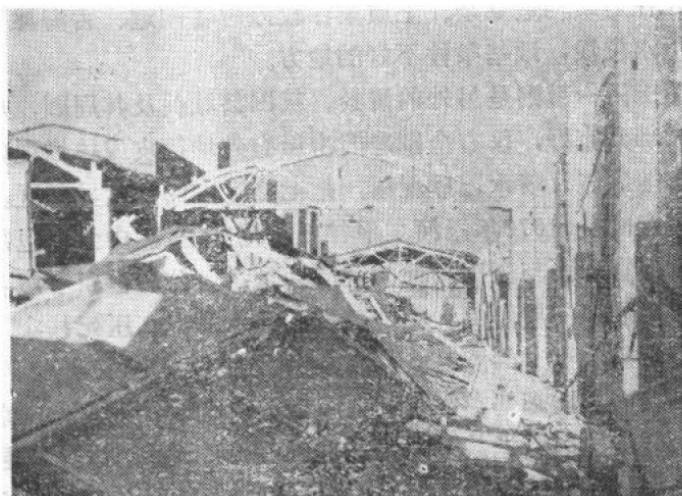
唐山第五陶瓷厂钢筋混凝土预制品新建厂房
